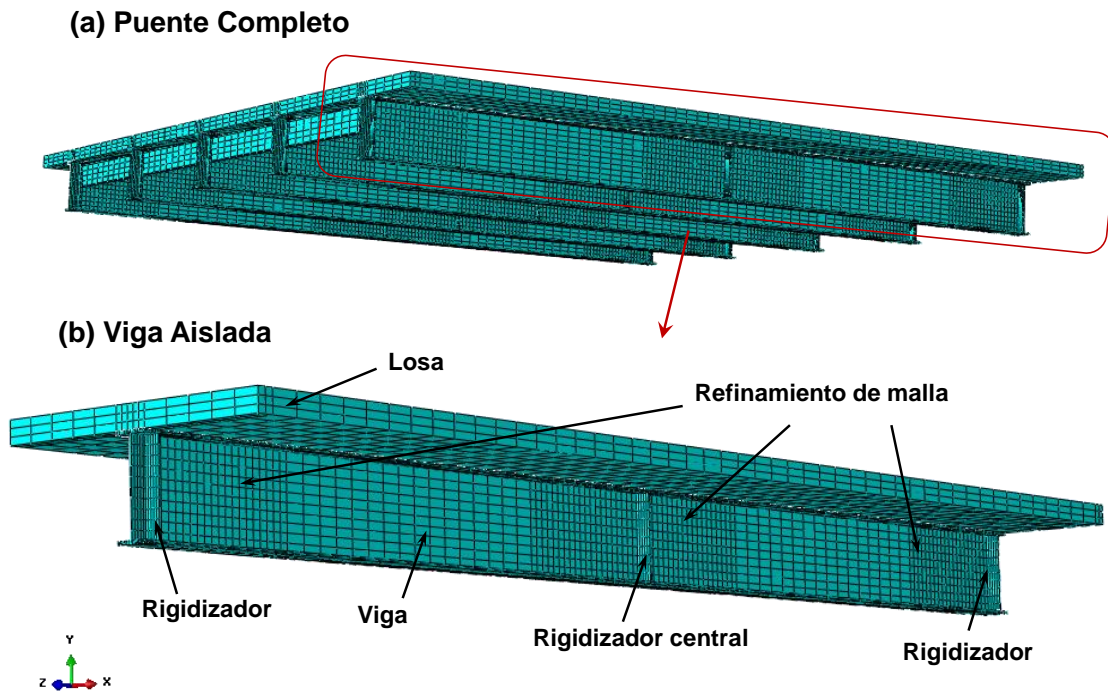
Modelo utilizado (Puente 12.2 metros) y mallado. a) Puente completo. b) Viga aislada.
